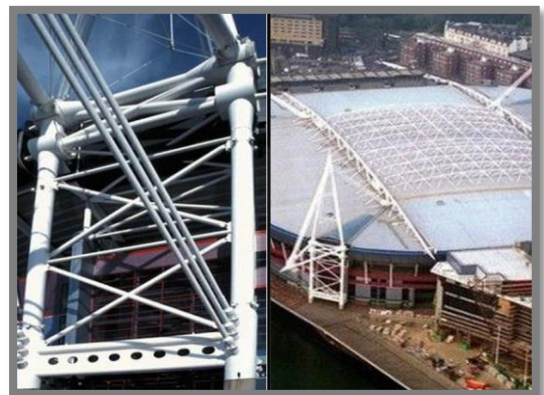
L'entrée principale est sous la poutre entre les jambes du mât.
